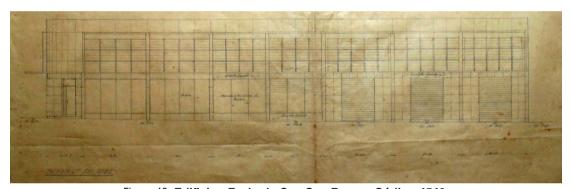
Edificio - Fachada Cra. San Roque. Código 4543.
